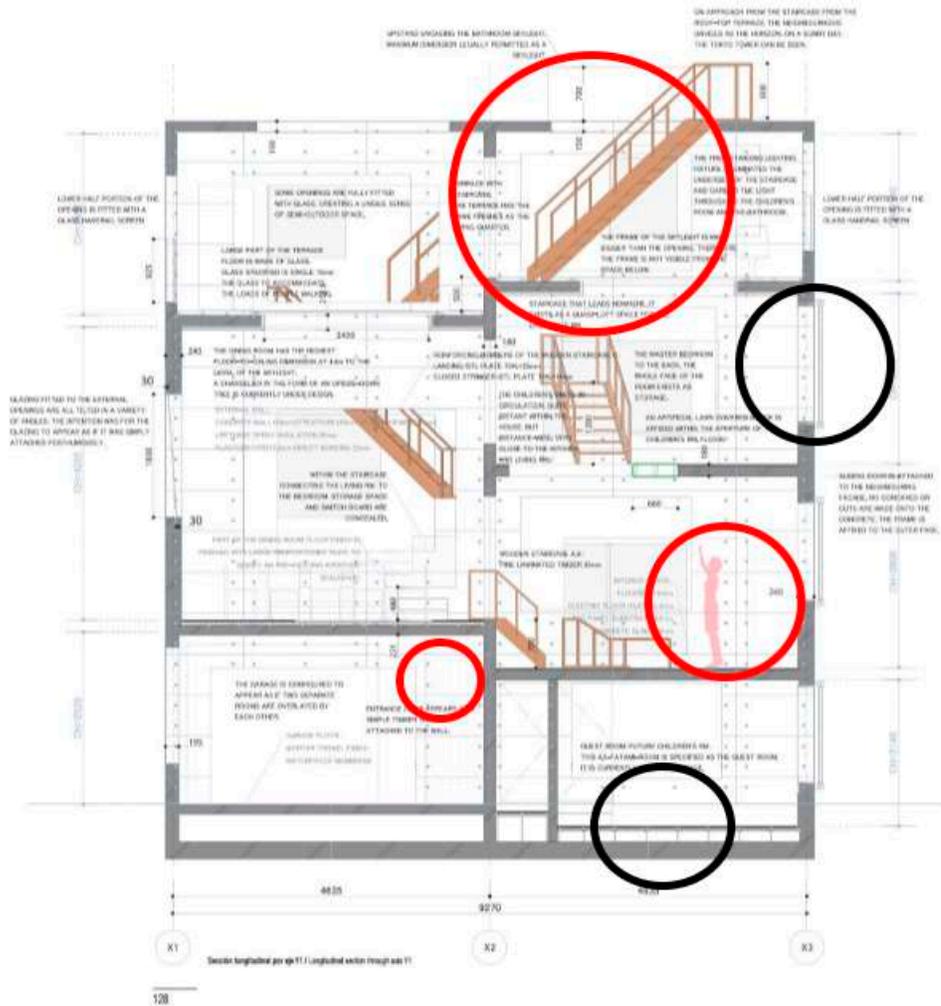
Planta fugada - House & Atelier Bow – Wow.
